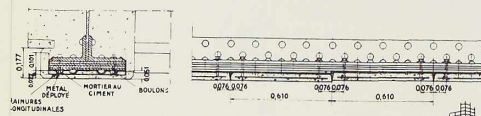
Dalles en béton moulées à l'avance boulonnées sous les ailes des poutres.
